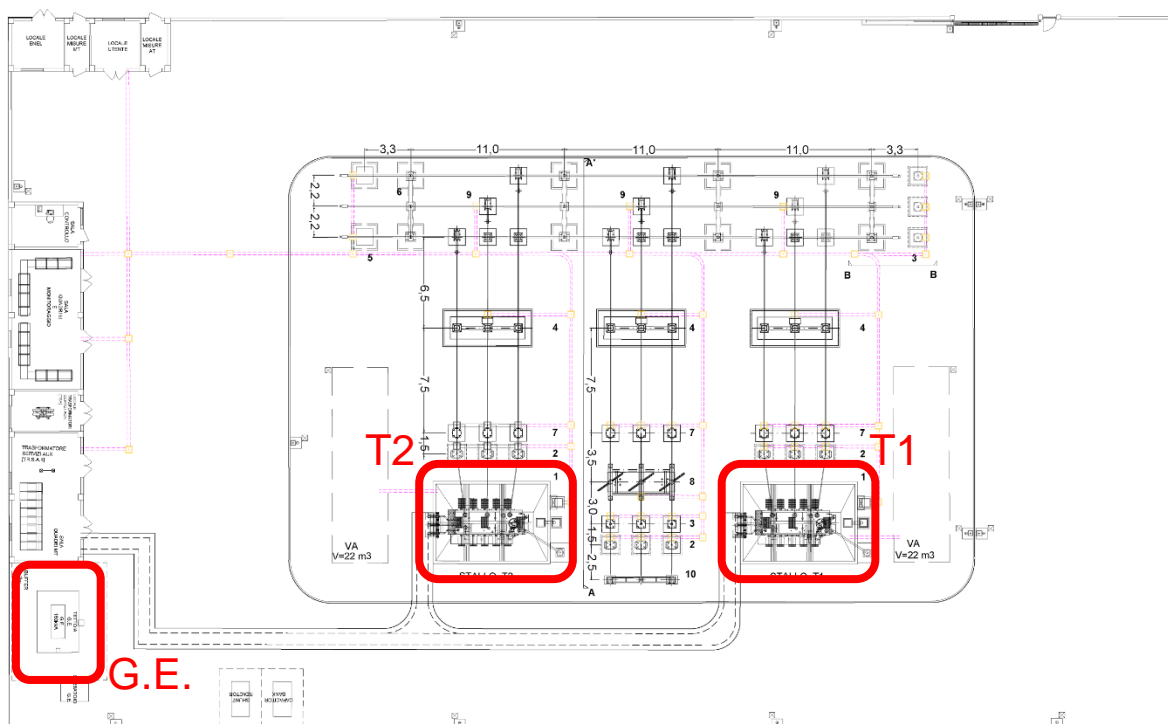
Planimetria della sottostazione elettrica utente 132/15 kV con indicazione delle due sorgenti di rumore (non attive contemporaneamente)
